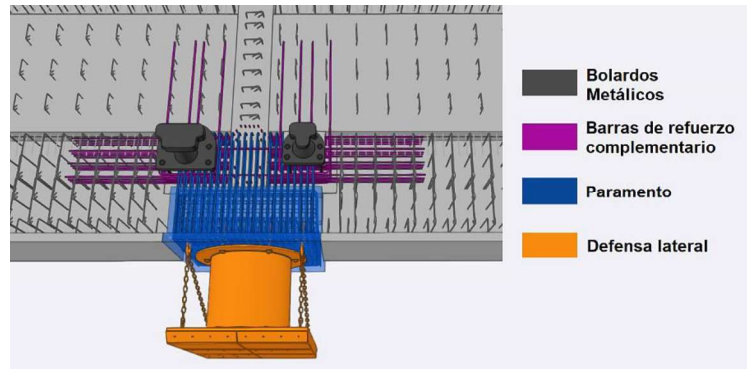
Conexión de bolardos y defensas con tablero. Elaboración propia
